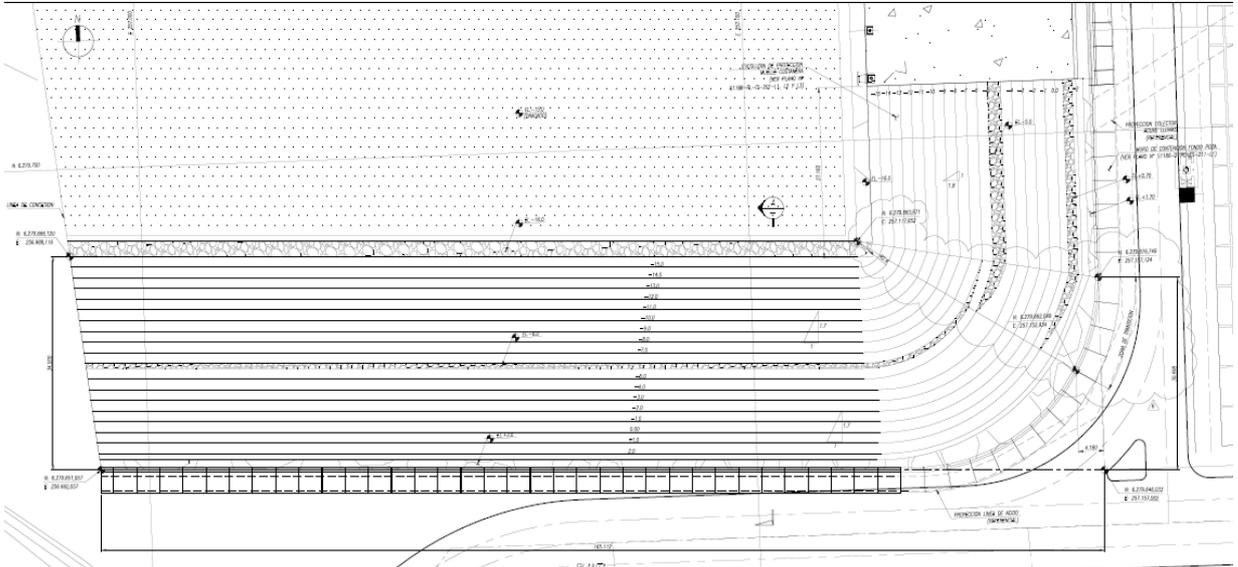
Planta Fondo de Poza con Talud de Enrocados y Muro de Contención
